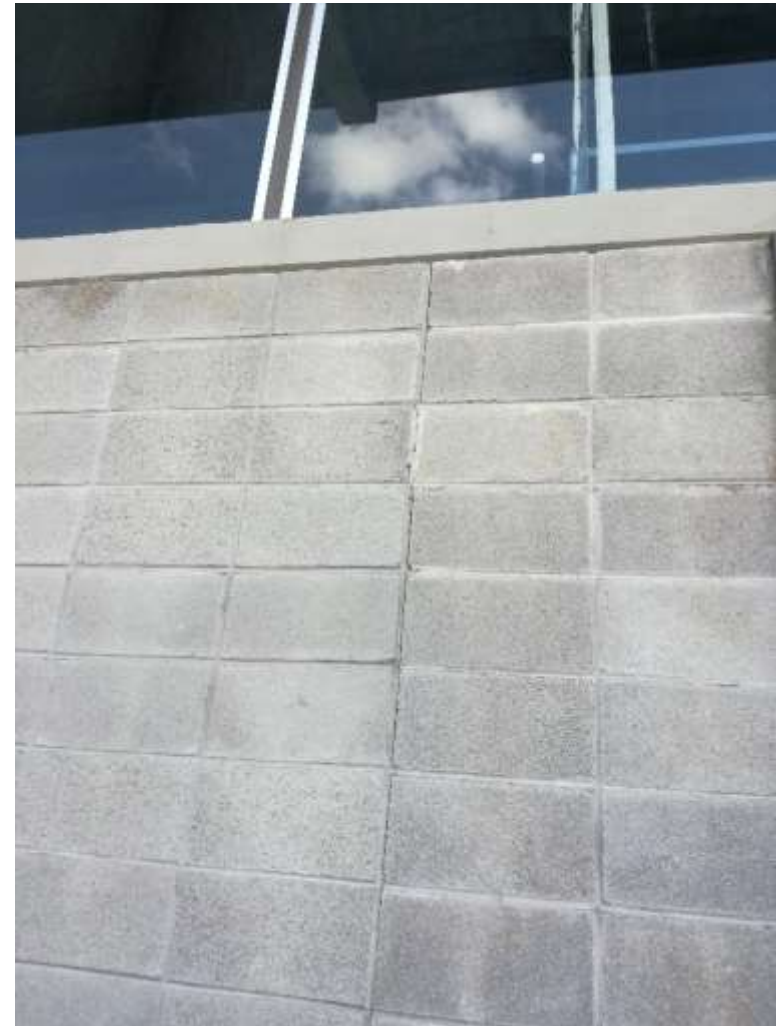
Grieta en muro sur del archivo de Concentración.
